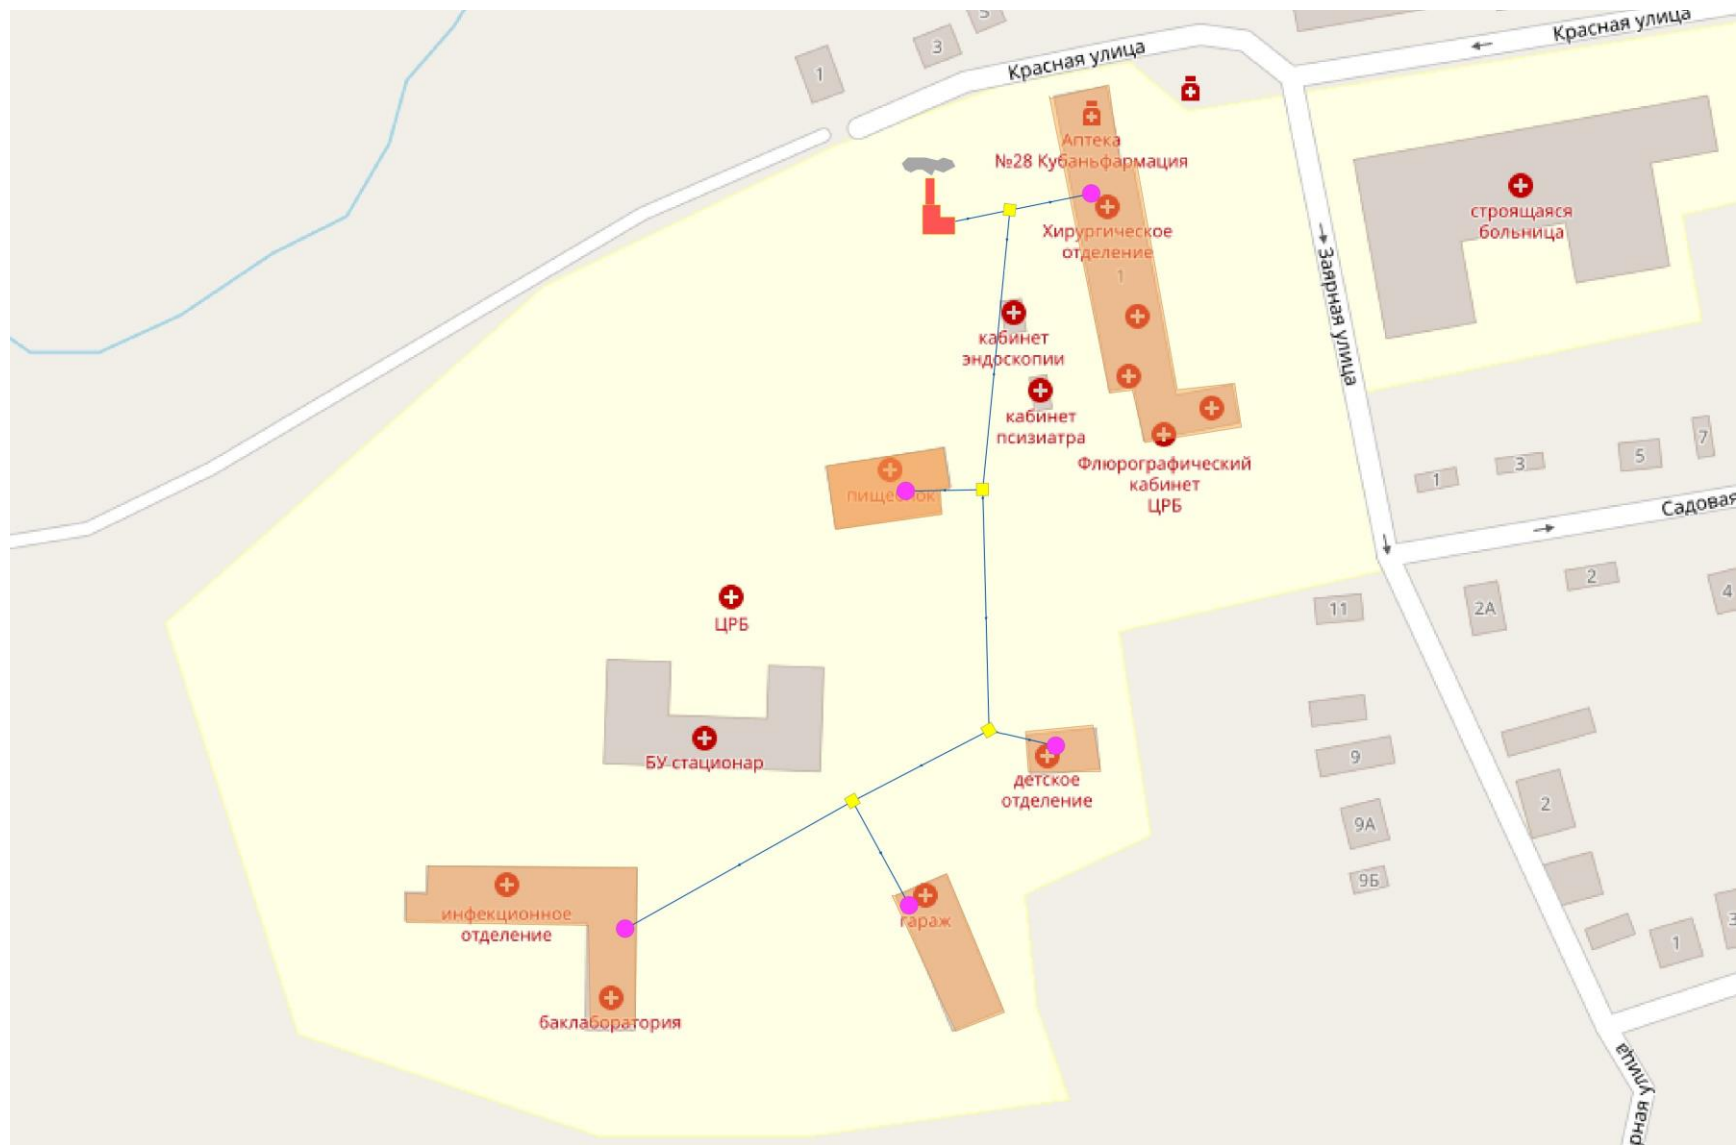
Схема теплоснабжения котельной ЦРБ
